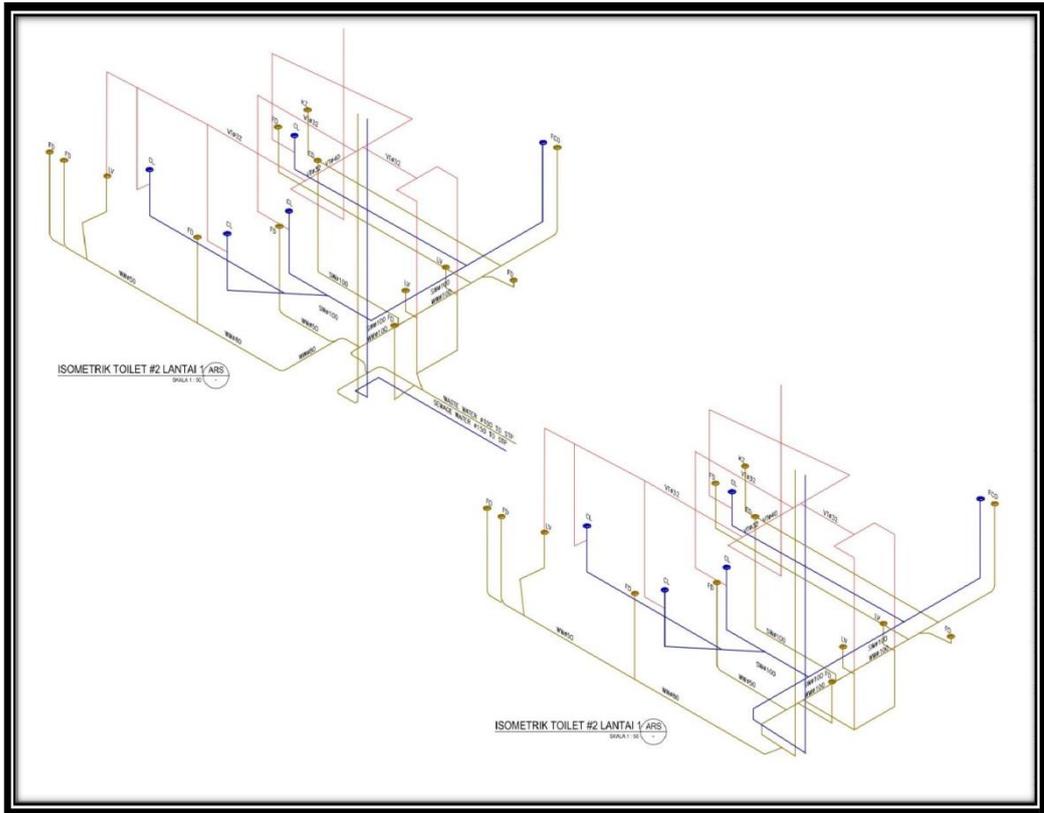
Detail Coring Sewage & Waste Water and Vent Model 1
